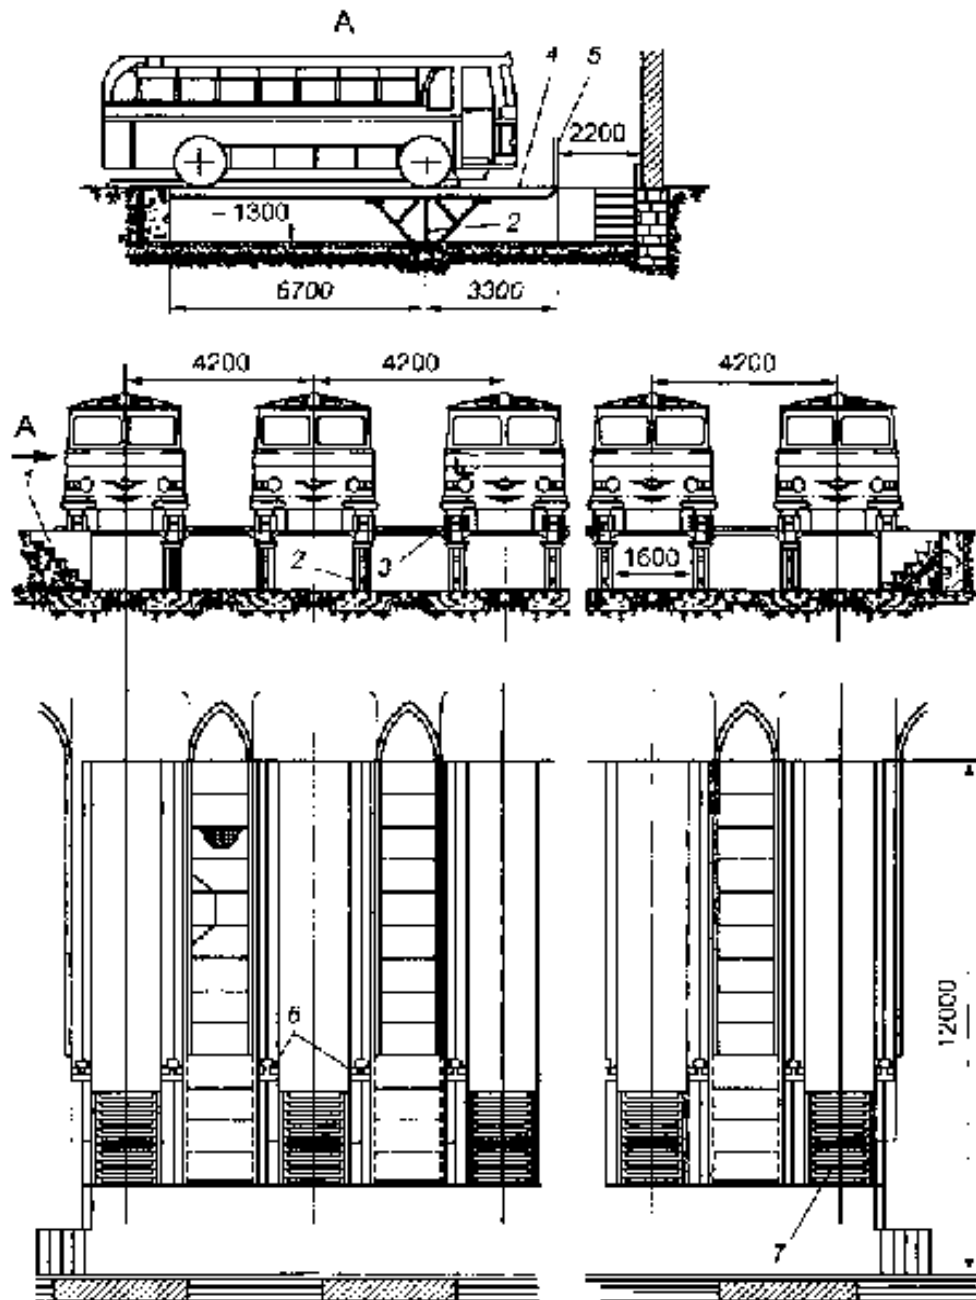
Осмотровые канавы узкого типа с общим подвальным помещением: 1 — лестница; 2 — металлическая опора; 3 — плиты перекрытия; 4 — съемный настил; 5 — ограждение; 6 — упоры; 7 — реборда
